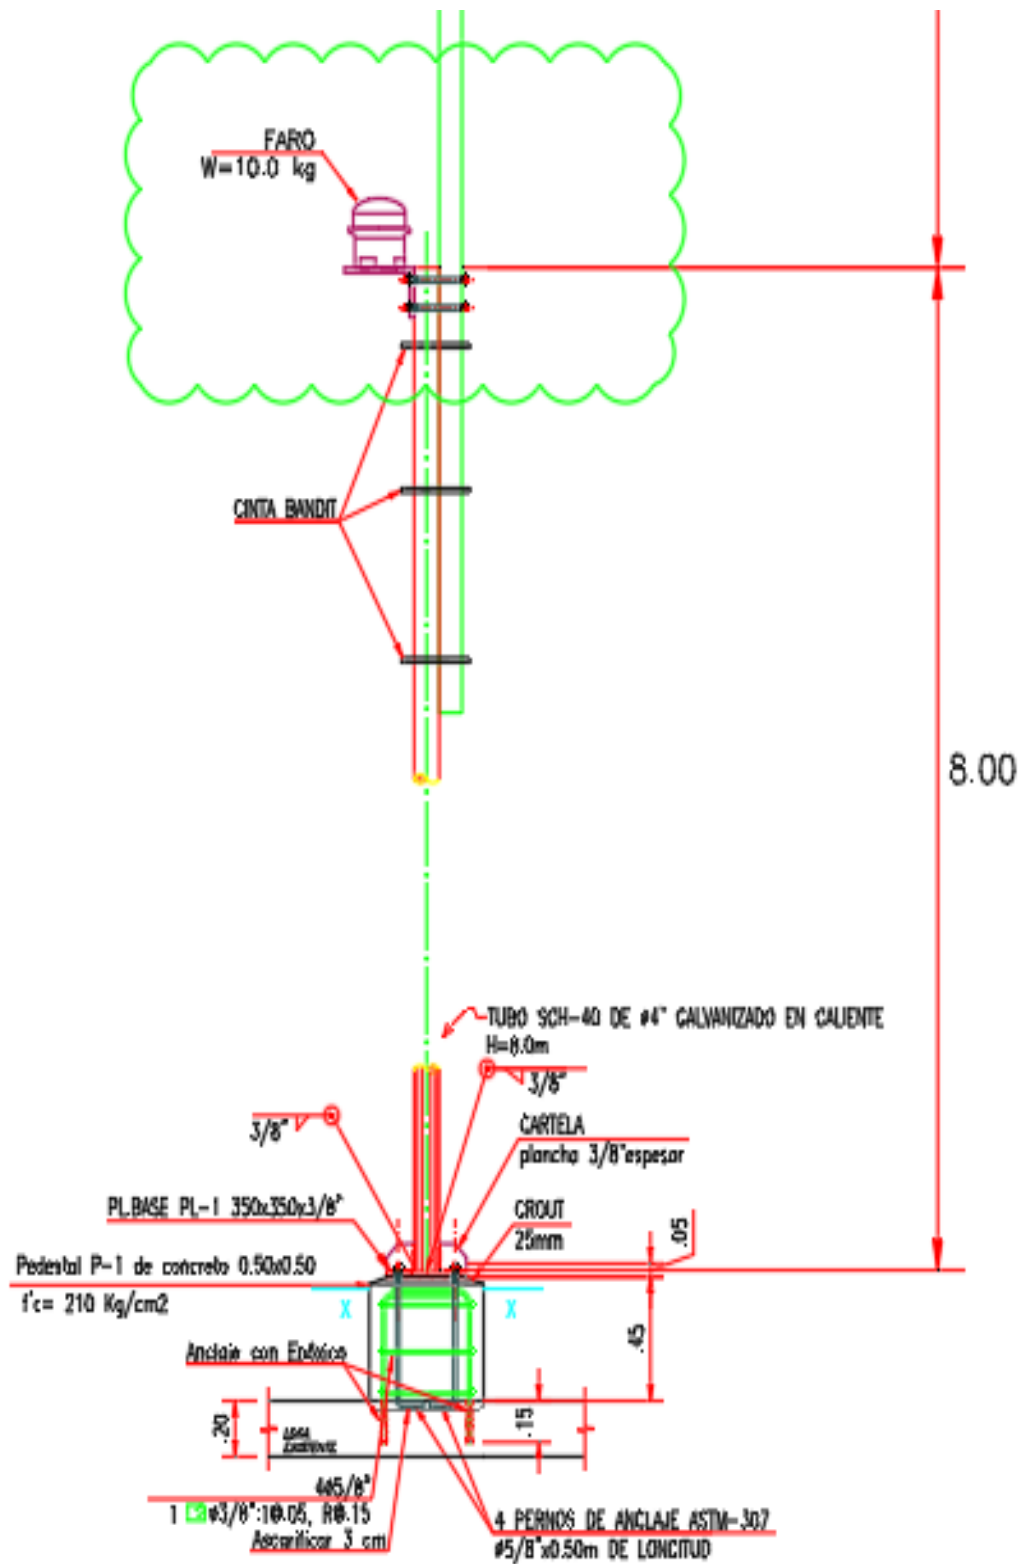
Detalles de Montaje de FARO de Helipuerto
